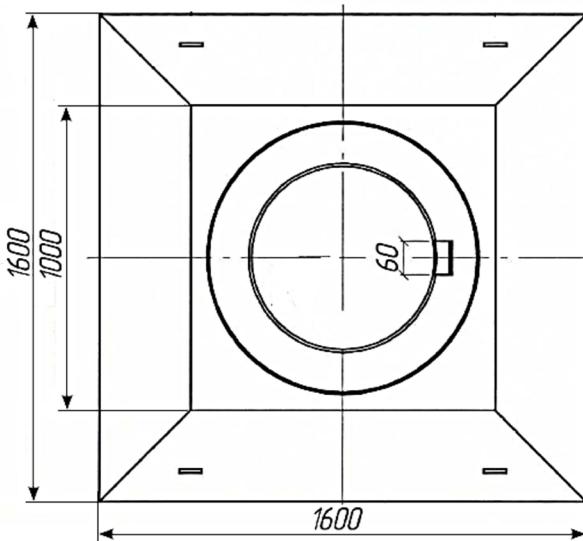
Размеры плиты ОП-1к-У, вид сверху.
